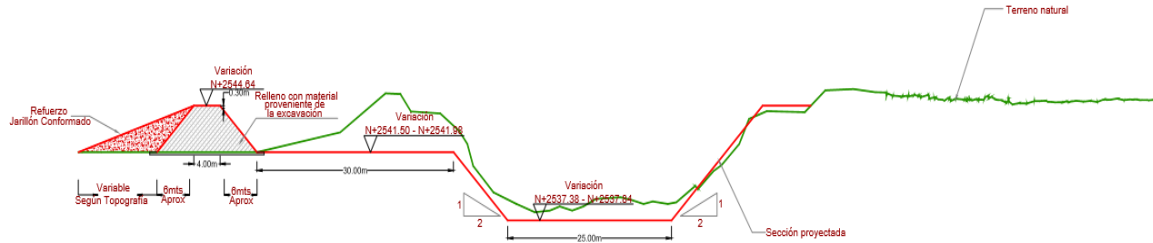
Sección típica 4 de corte transversal Aeropuerto.
